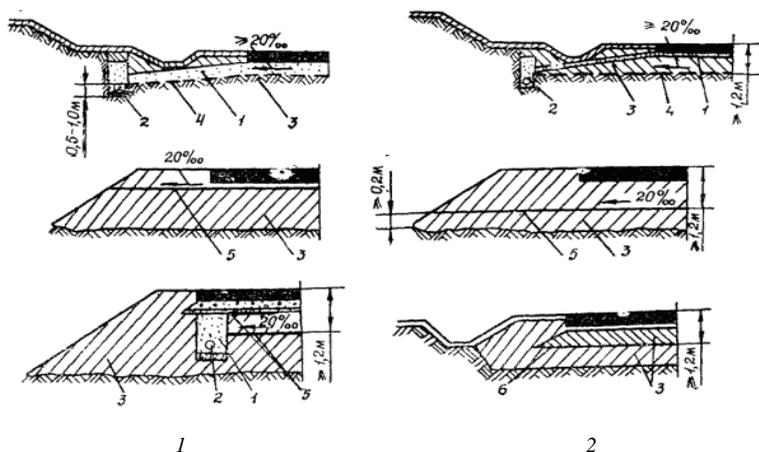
Закладка дренажных труб: 1 – дренирующий слой; 2 – дренажная труба
